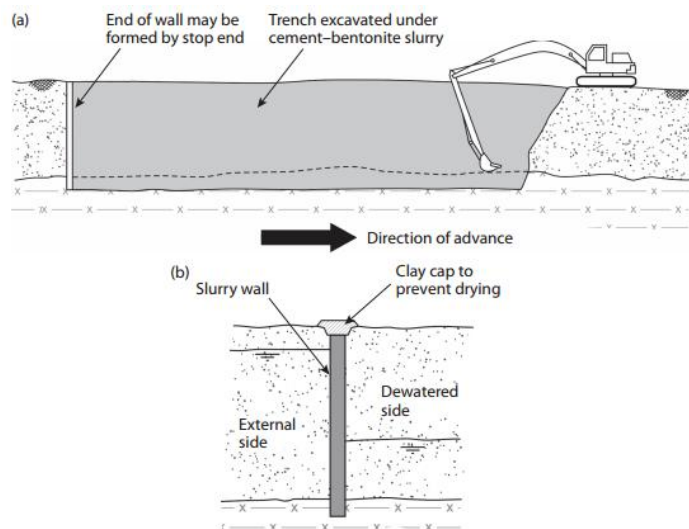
a) Ilustração do processo construtivo de uma parede de lamas; b) Corte transversal usual neste tipo de barreiras. (fonte: Groundwater Lowering in Construction [4])
